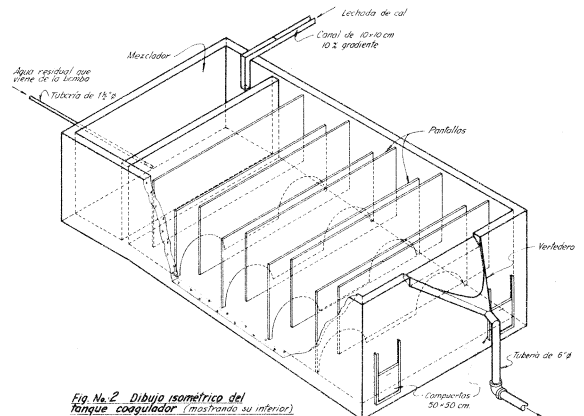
Dibujo isométrico del tanque coagulador (mostrando su inferior)
